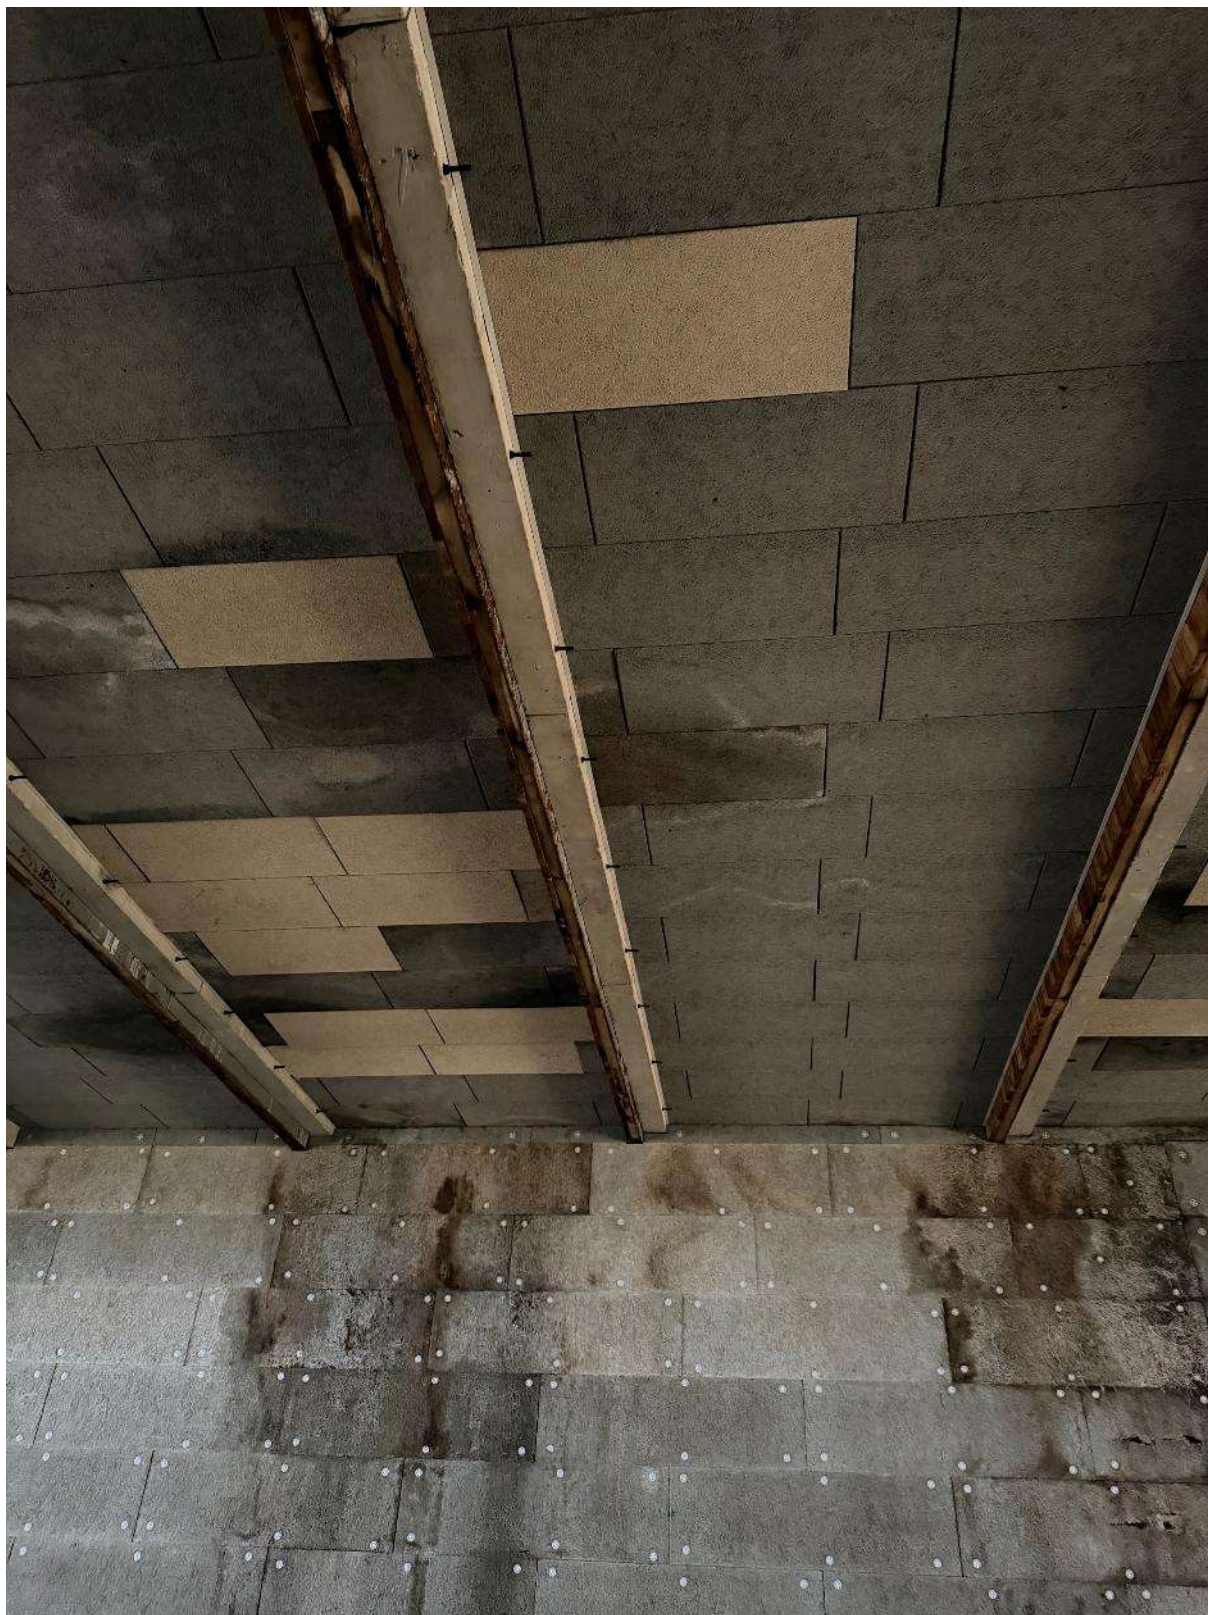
zone avec rebombée et protection pour bloquer les tirs trop hauts
